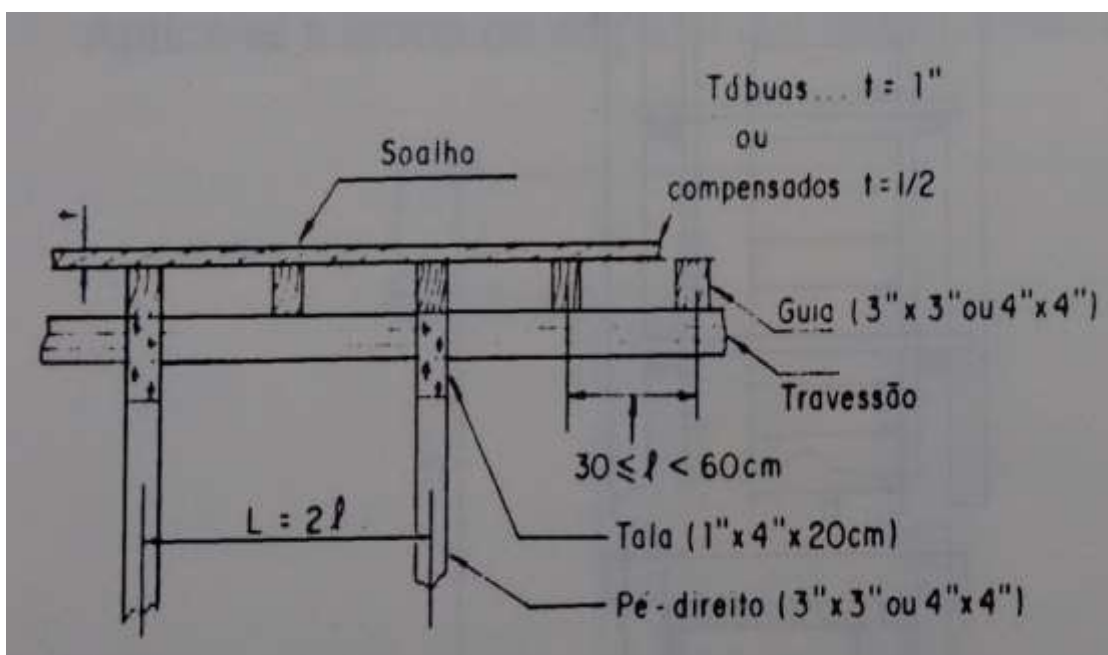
Detalhamento de fôrmas de madeira com chapas de compensada para laje maciça.
